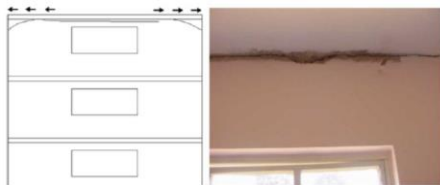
Fissura horizontal causada pela movimentação da laje de cobertura. [6]
